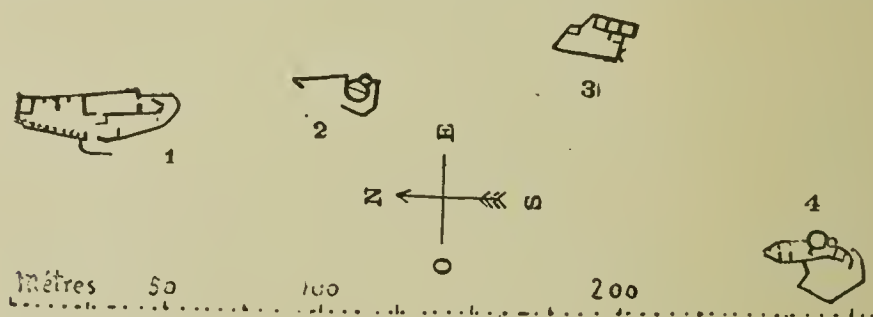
PLAN DES CHATEAUX DE CABARET.
